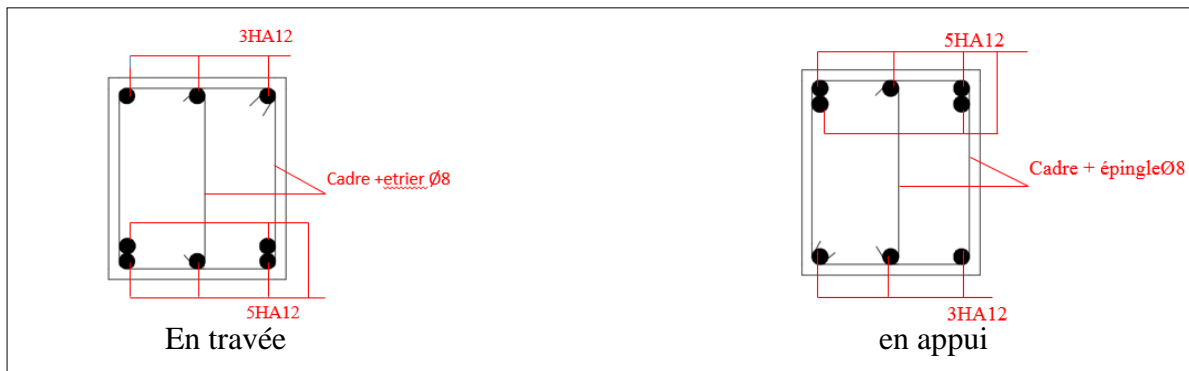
schéma de ferrailage de la poutres secondaires 6^{eme}, 7^{eme} étages.
